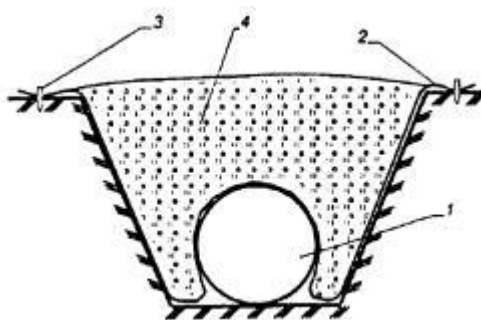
Способ балластировки газопроводов минеральным грунтом засыпки с использованием полотнищ из НСМ: 1 – трубопровод; 2 – полотнище из НСМ; 3 – металлический штырь; 4 – грунт засыпки.
